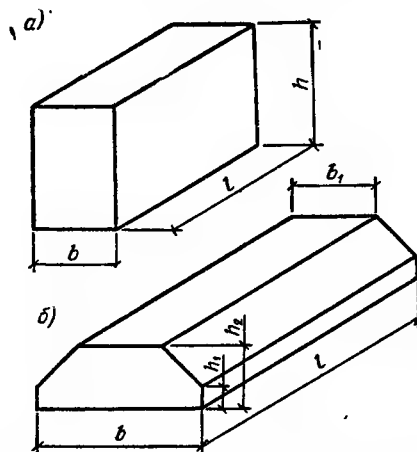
Блоки сборных ленточных фундаментов и стен подвалов
